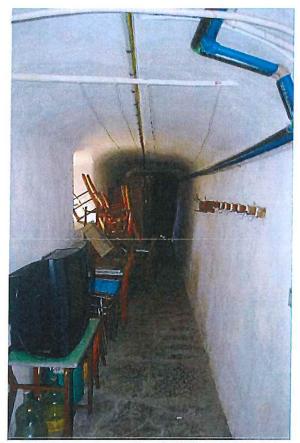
,14 | Piano terra: magazzini (sx) e corridoio (dx).
